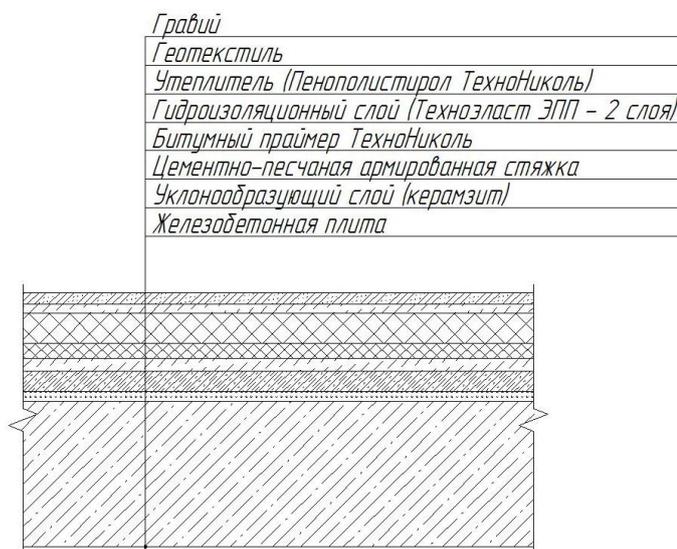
Инверсионная кровля без пароизоляции
